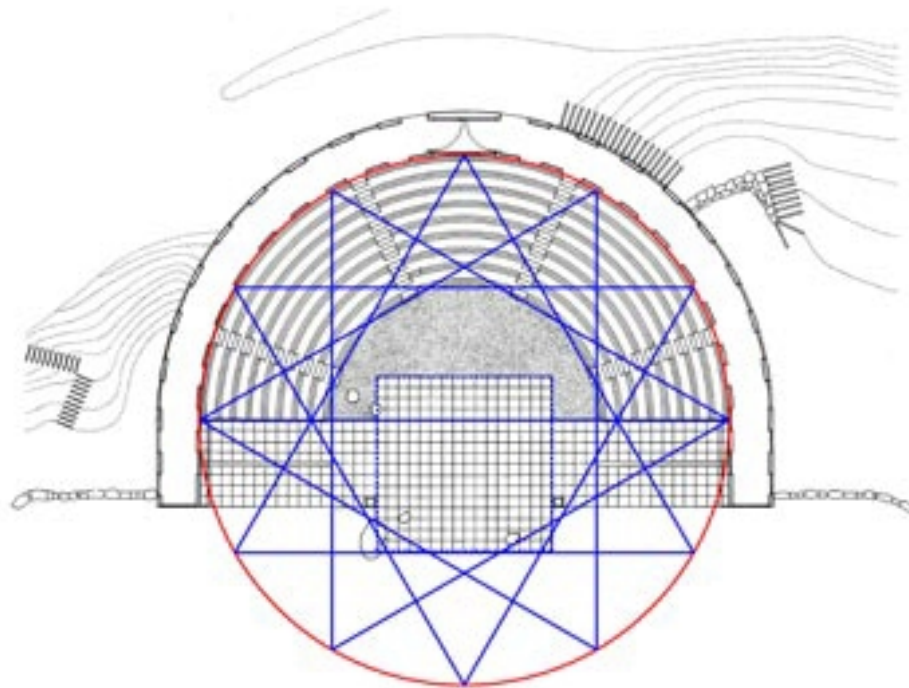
Estudo para planta baixa do Anfiteatro. Fonte: Arata Isozaki (2014). Acervo da autora.
